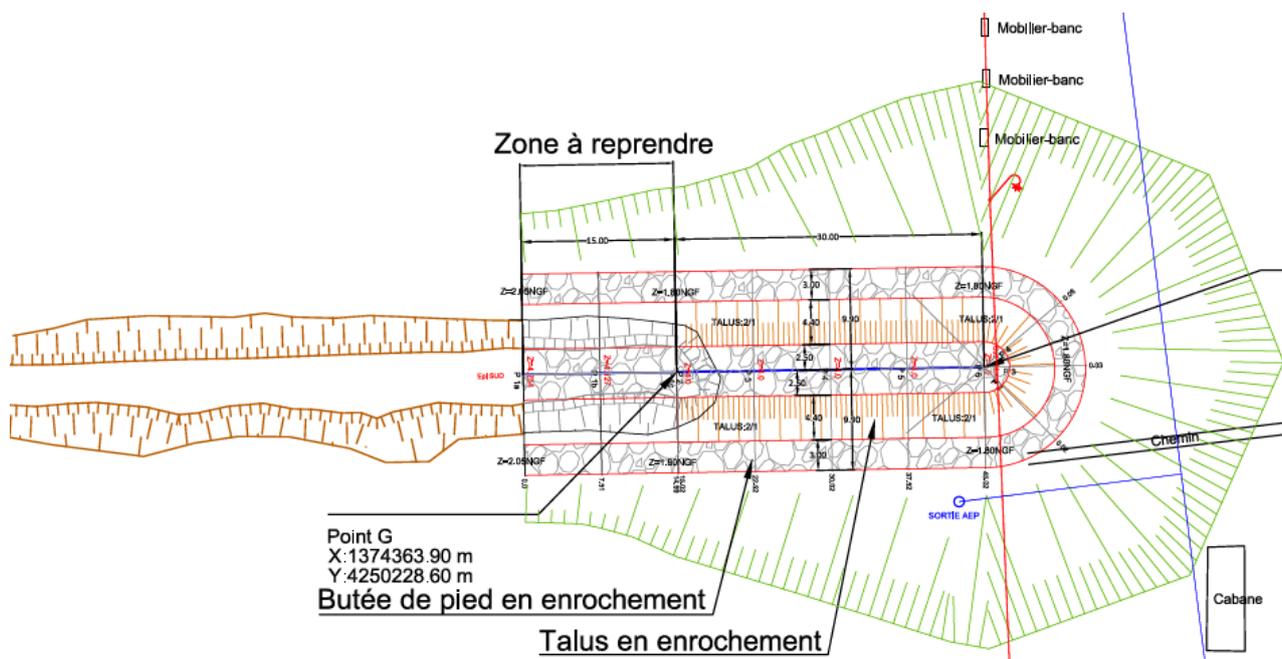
VUE EN PLAN DES TRAVAUX D'URGENCE DE L'ÉPI SUD (REF. [5])
